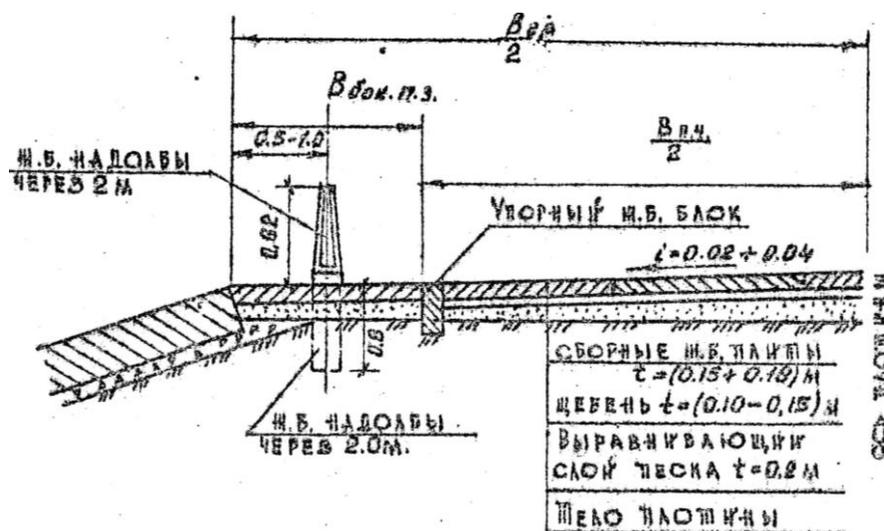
Гребень плотины с покрытием из железобетонных плит
